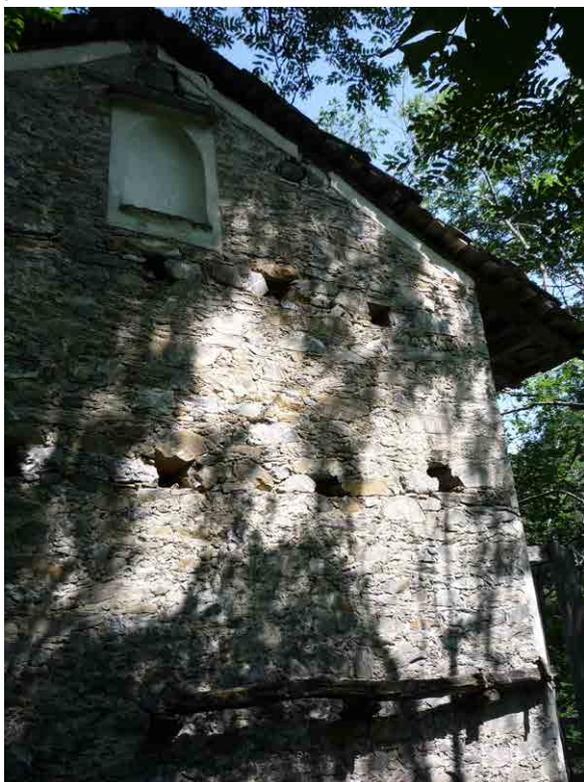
| Prospetto laterale (Lele Viola, 2013)
